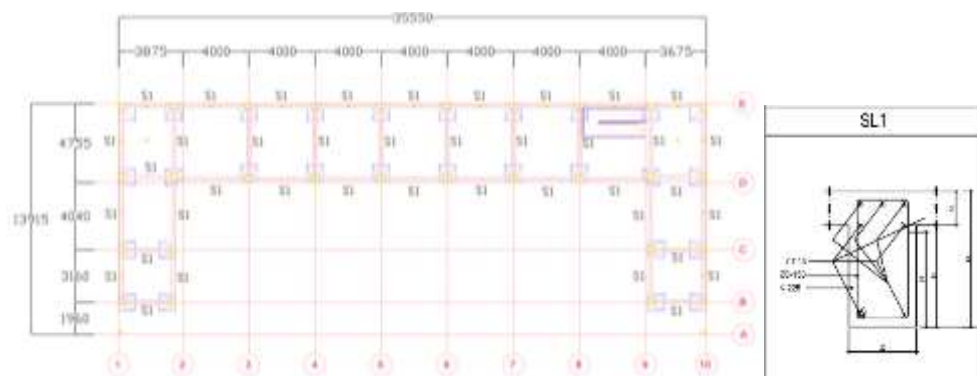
Denah dan Detail Pondasi Bangunan Sekolah
